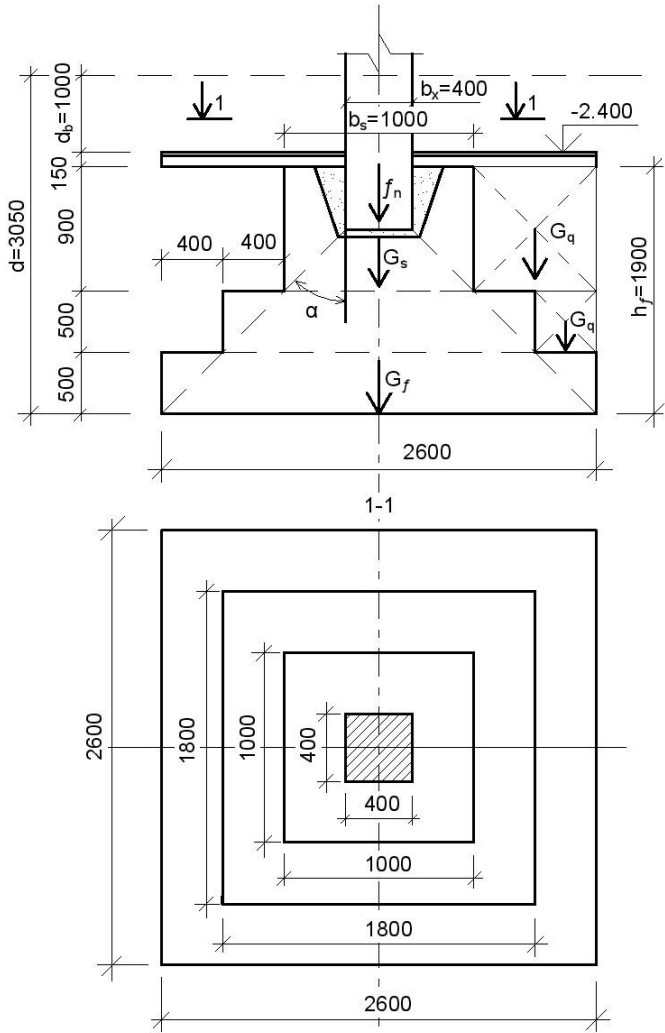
Схема монолитного железобетонного столбчатого жесткого фундамента стаканного типа
